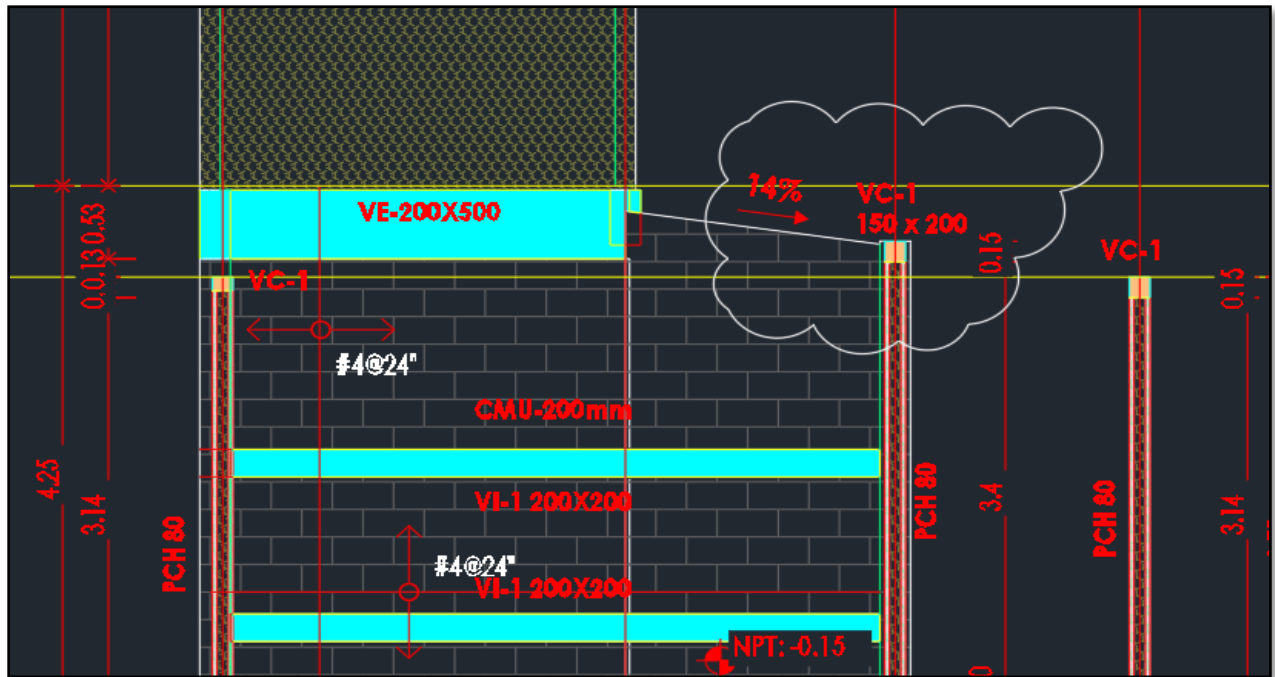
Dibujo en planos estructural Eje I -Detalle VC-15x200
